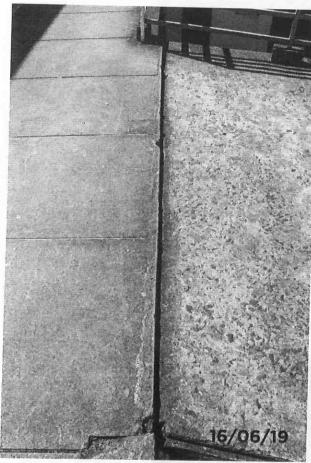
Detalhe junta de dilitação Av. São Paulo com a Passarela apresentando segregação do concreto, lábios poliméricos destruídos e trincas.
